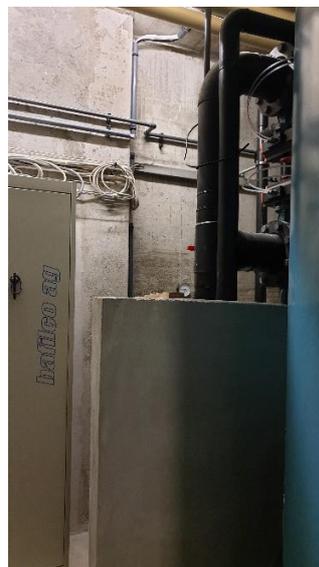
Zugang Ausgleichsbecken und Rückhalteschacht
